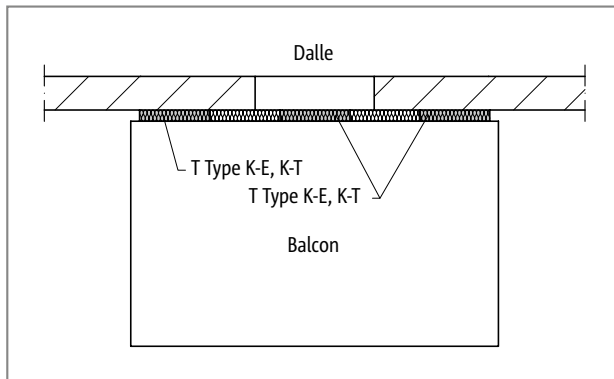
Schöck Isokorb® T Type K-E, K-T : Balcon en porte-à-faux
